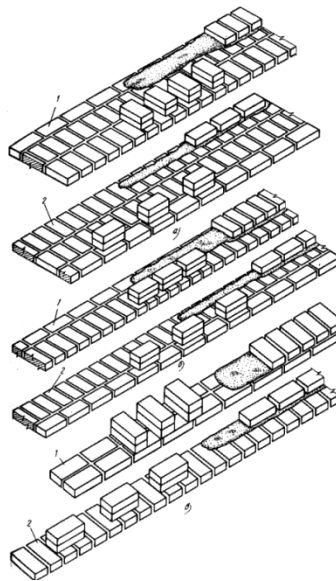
Раскладка кирпича при кладке стен толщиной:
